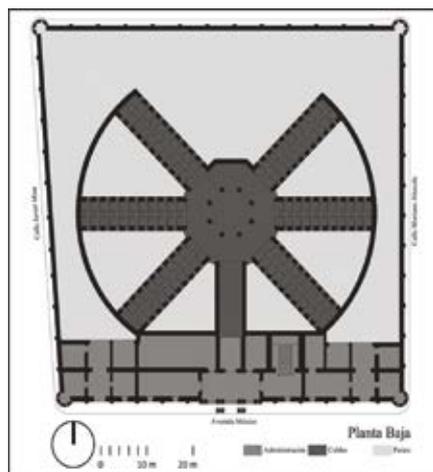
Reconstrucción de la planta arquitectónica baja de la Penitenciaría de Tepic en 1880.
